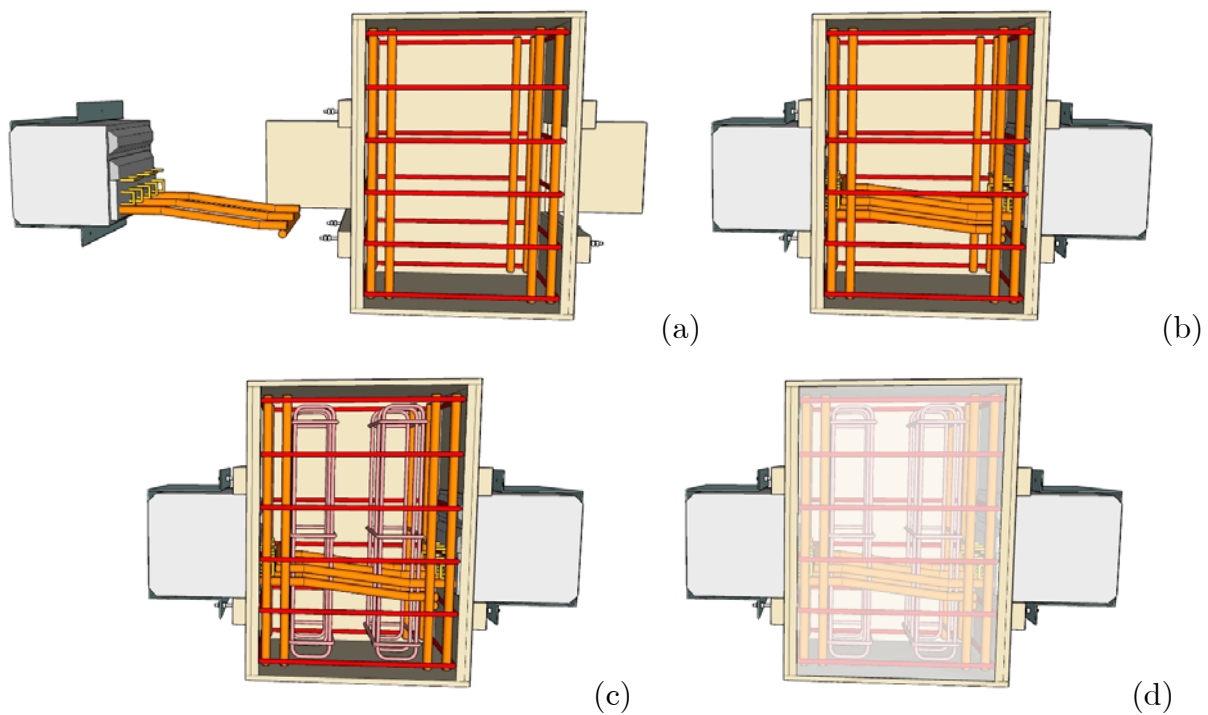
Esquema de concretagem do trecho de pilar.
